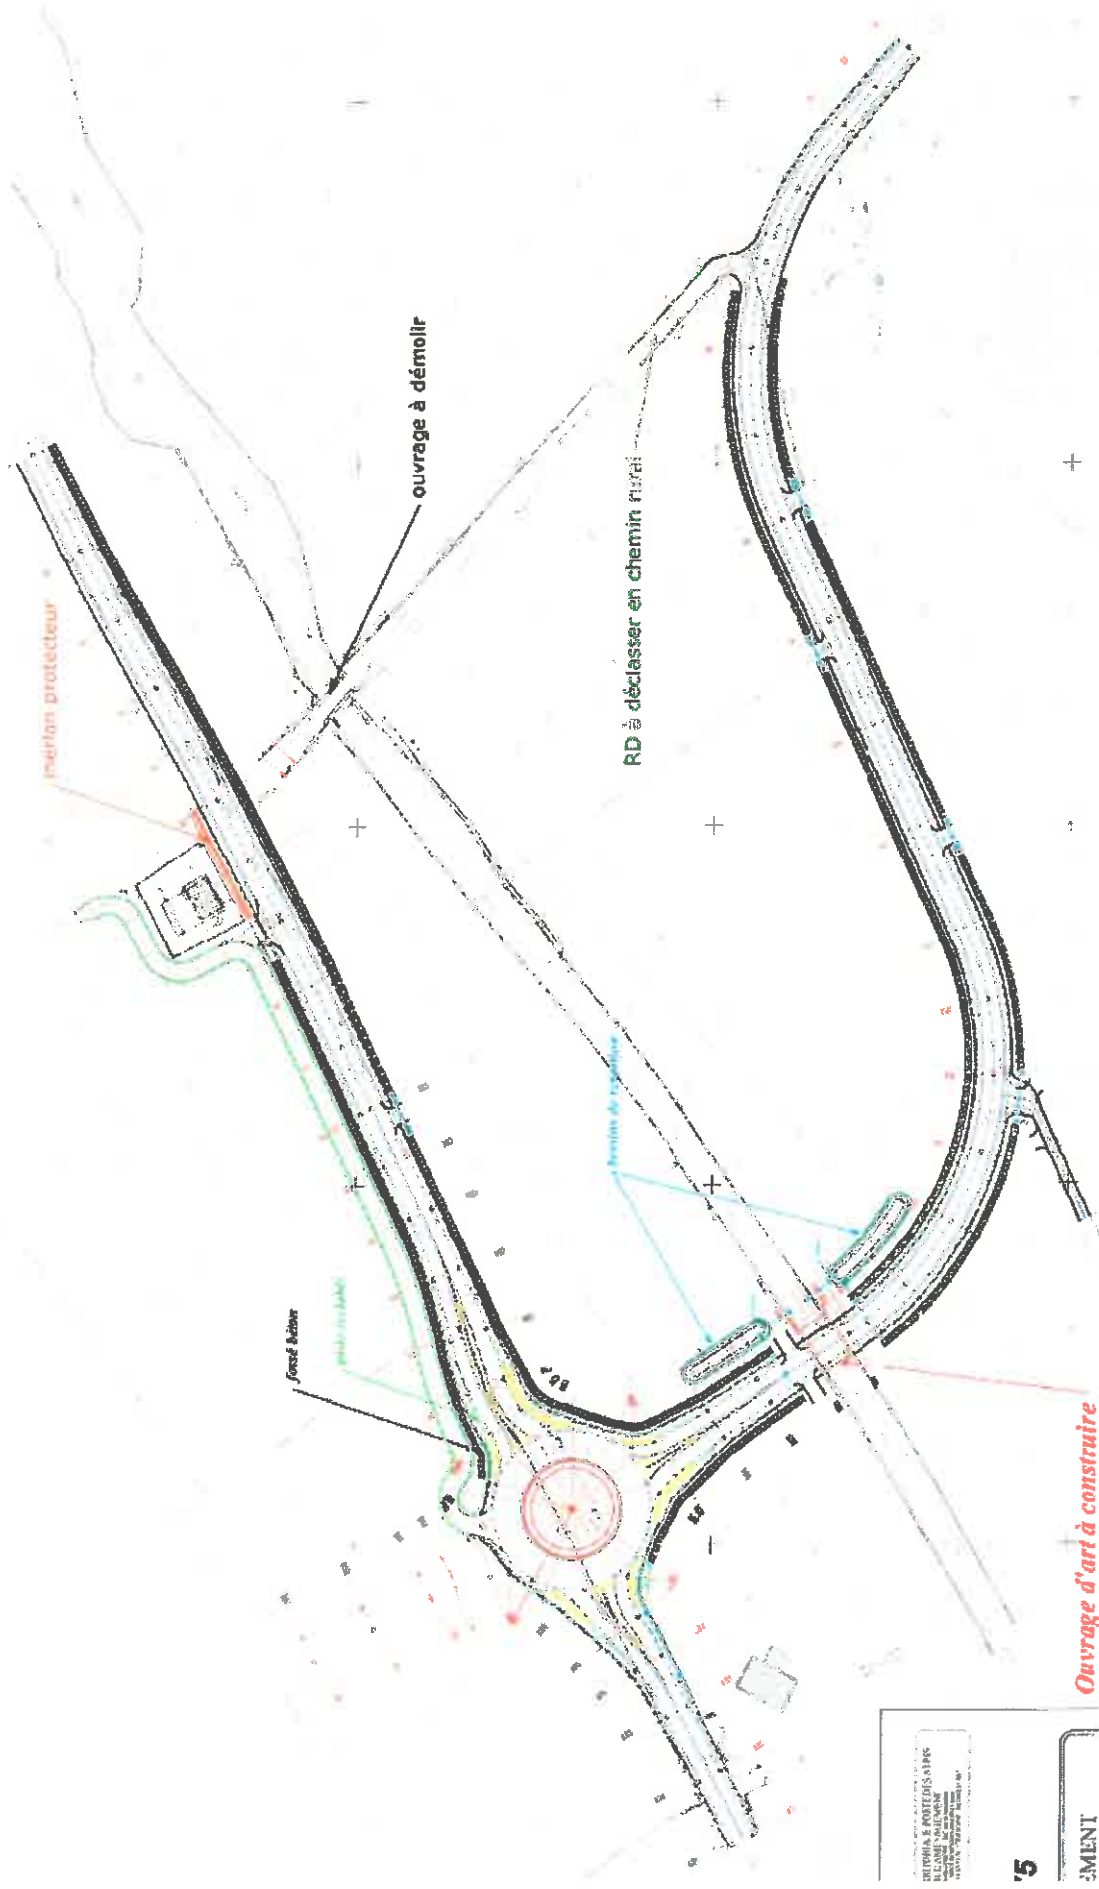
Plan projet de modification du carrefour RD 75 / RD 75b
